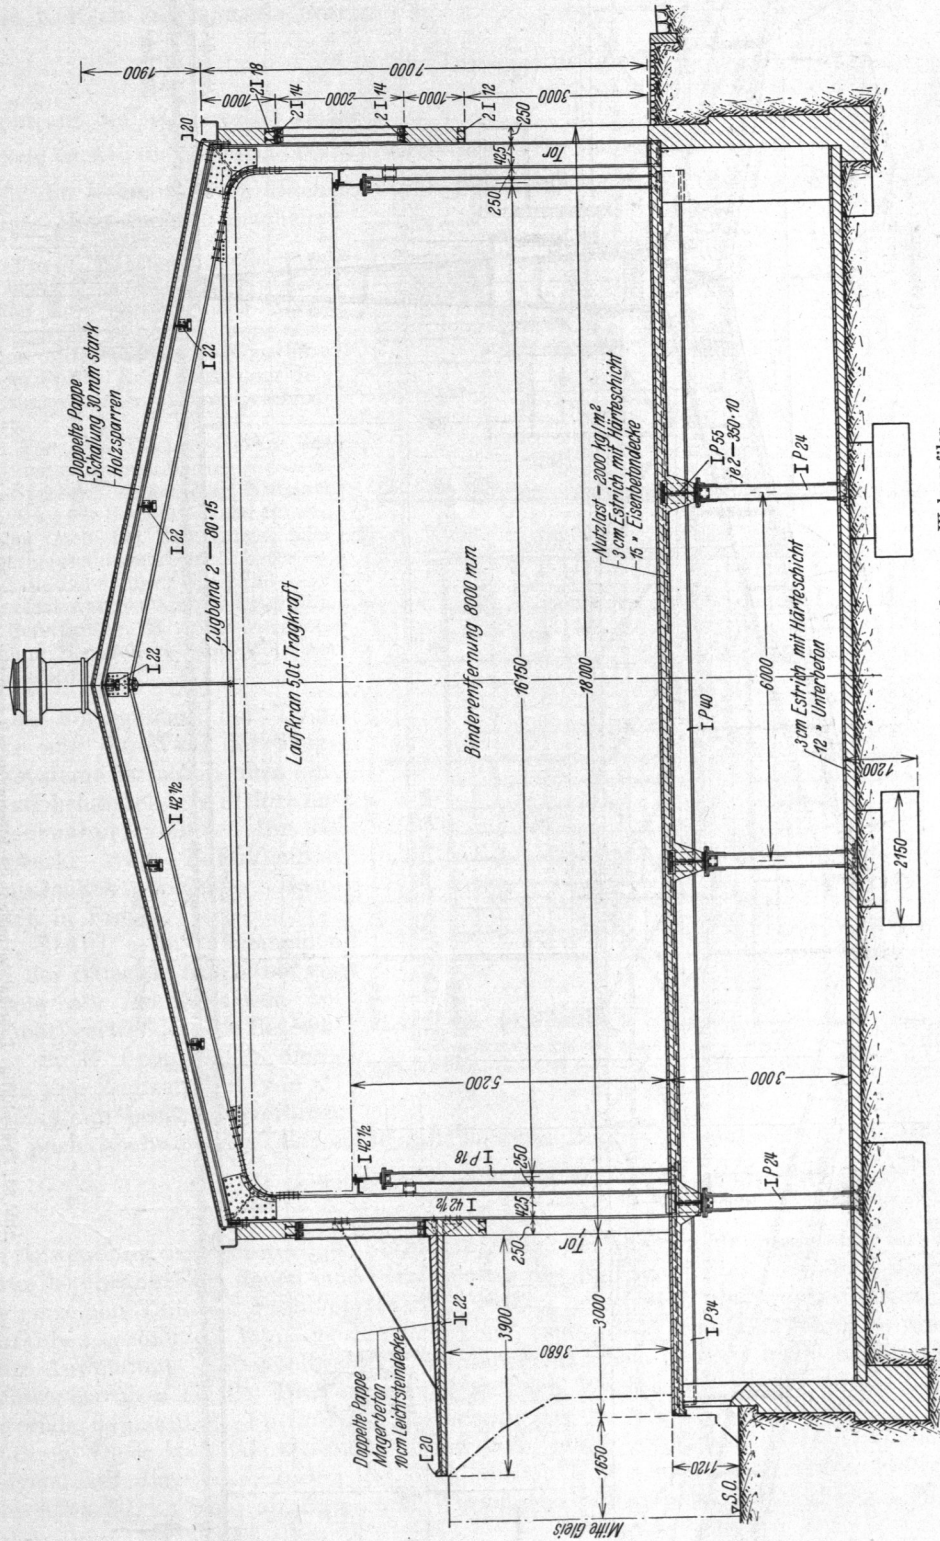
Unterkellerter Lagerhalle in Stahlbauweise mit Bindern aus Walzprofilen.
